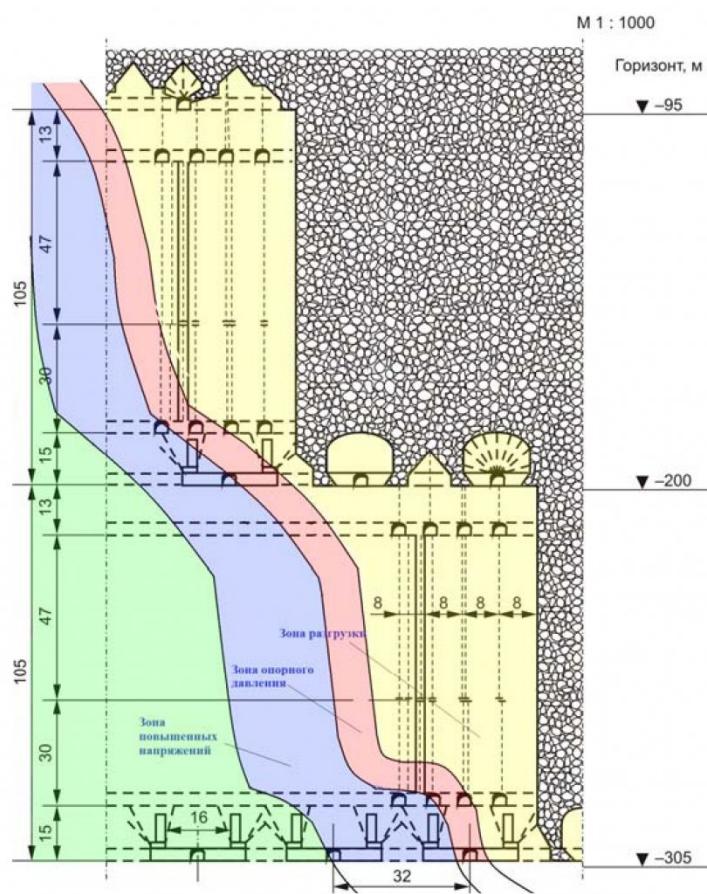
Вариант системы разработки этажного принудительного обрушения с отбойкой руды на за-
